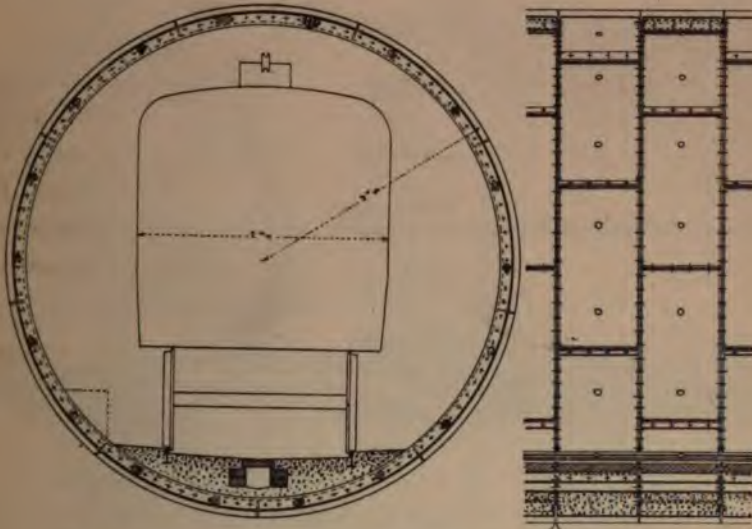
Coupes transversale et longitudinale du revêtement.
